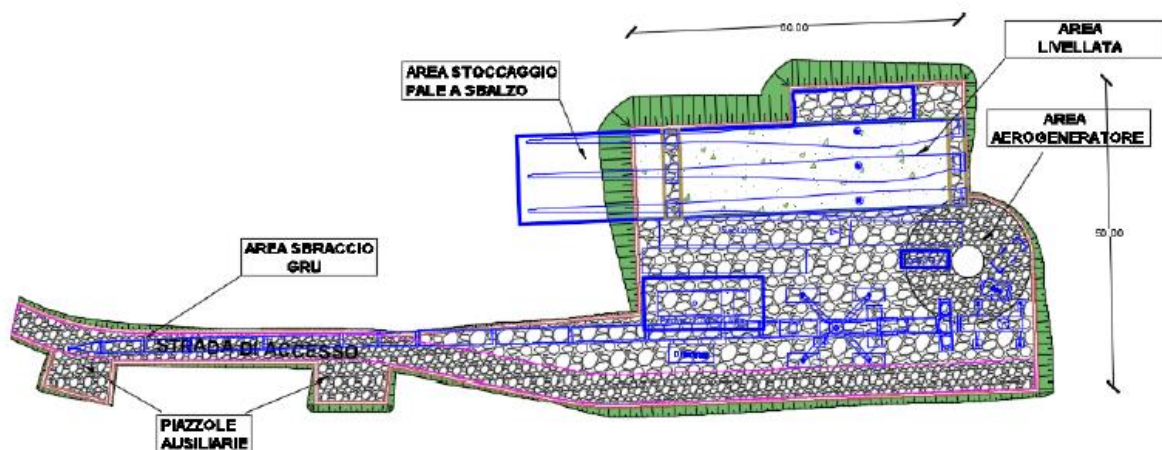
Planimetria piazzola tipo in fase di esecuzione lavori
